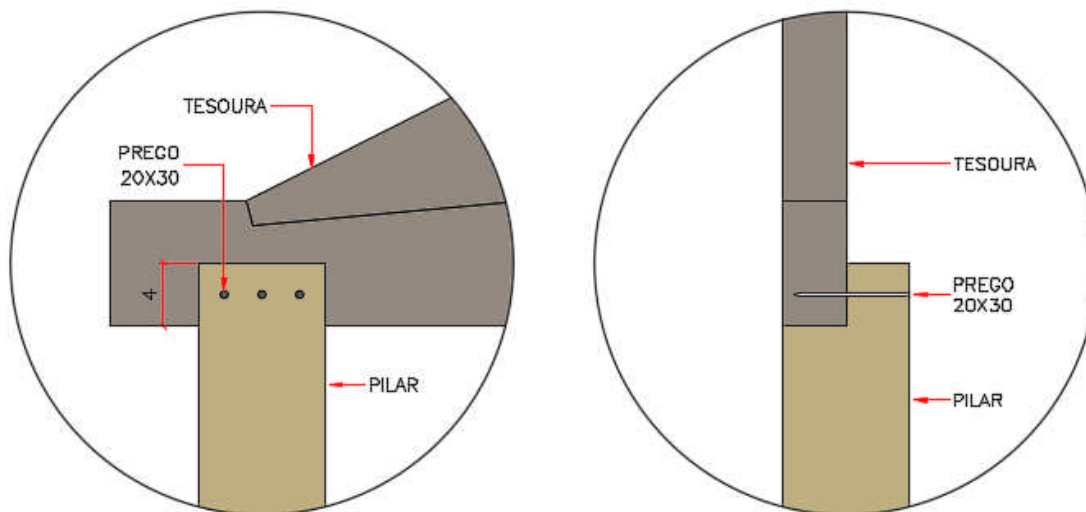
LIGAÇÃO ENTRE TESOURA E PILAR
